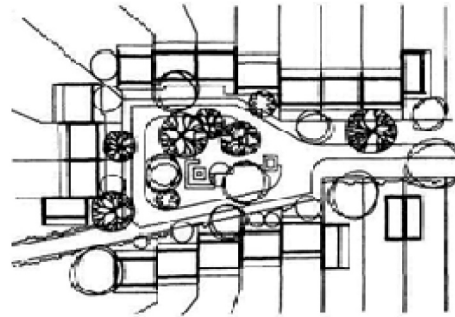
Планувальне рішення забудови блоковими двоповерховими будинками садибного типу
